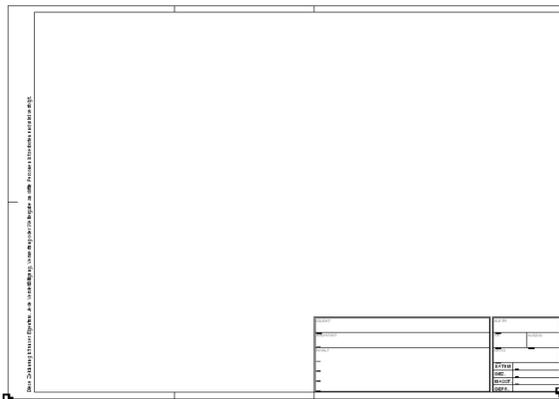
Einfügepunkte für Planrahmen und Plankopf
